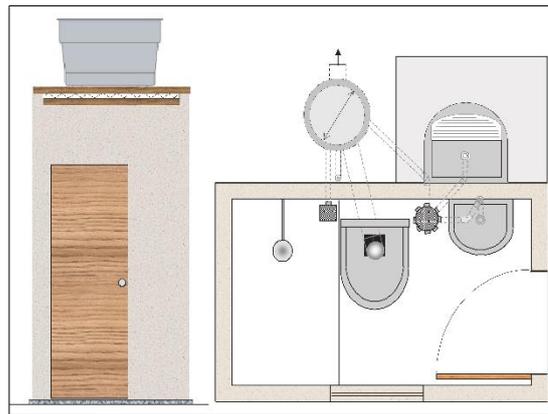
Desenho e planta baixa do módulo sanitário proposto pela Funasa.
